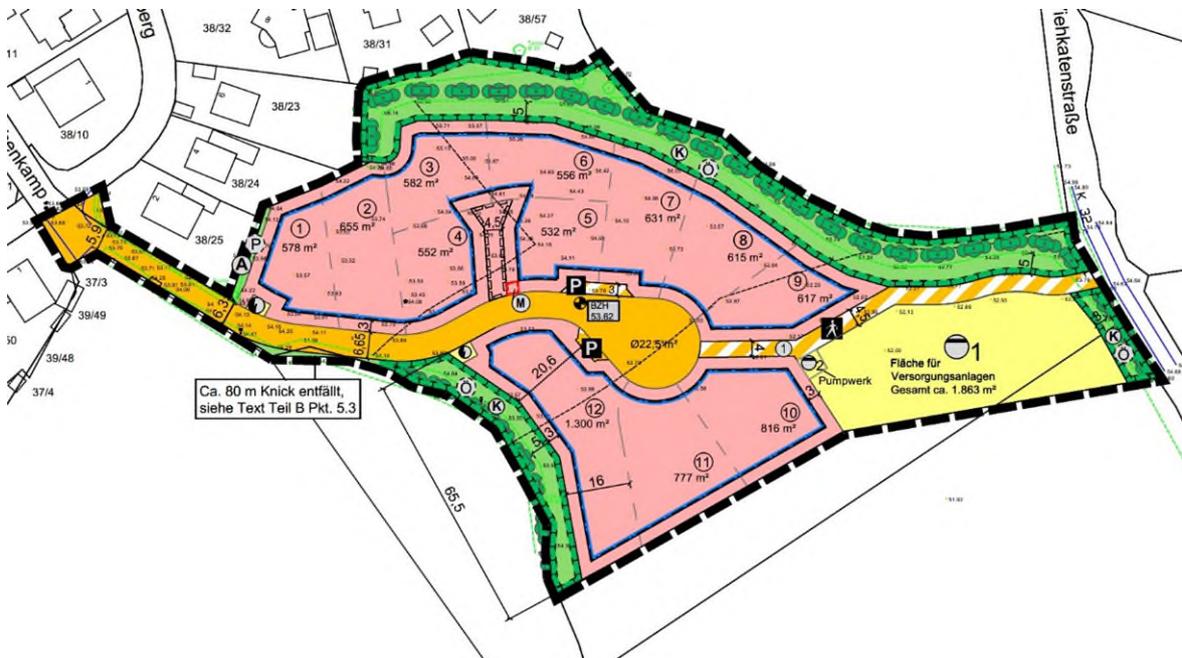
Ausschnitt aus der Planzeichnung des B-Plans Nr. 25
